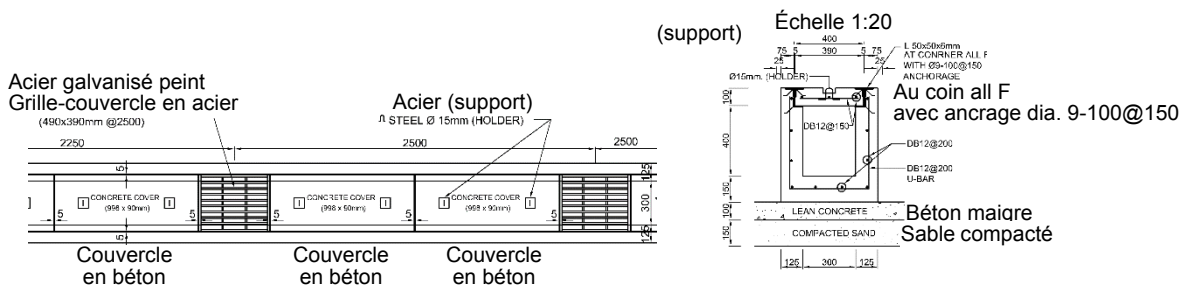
Le plan général et le profil type de la tranchée en forme de U en béton armé
